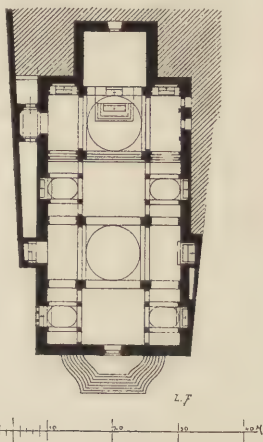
St. Fiora e Lucilla (Badia) zu Arezzo. Grundriss.
